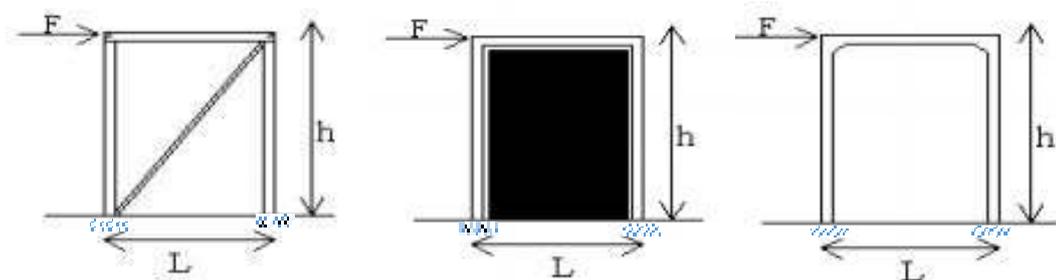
1.(a). Susunan elemen kolom dan balok,
